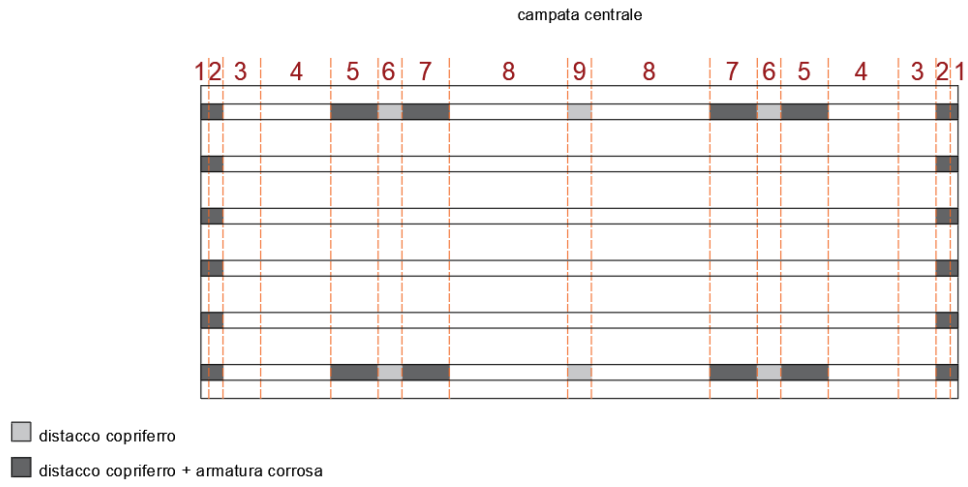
Ponte sul torrente Mavigliano, Caso I_ev2 schema deterioramento in pianta
